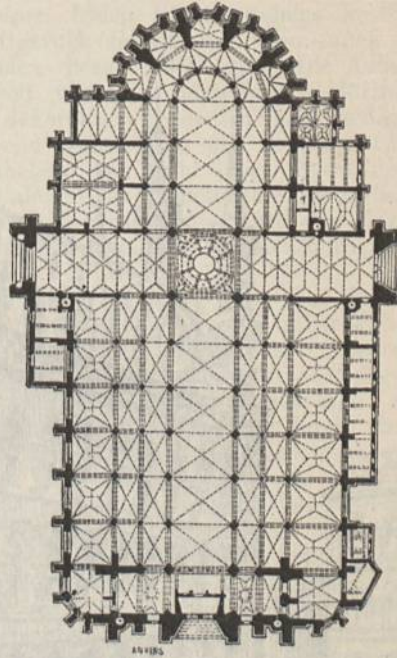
Grundriss des Doms zu Antwerpen.
